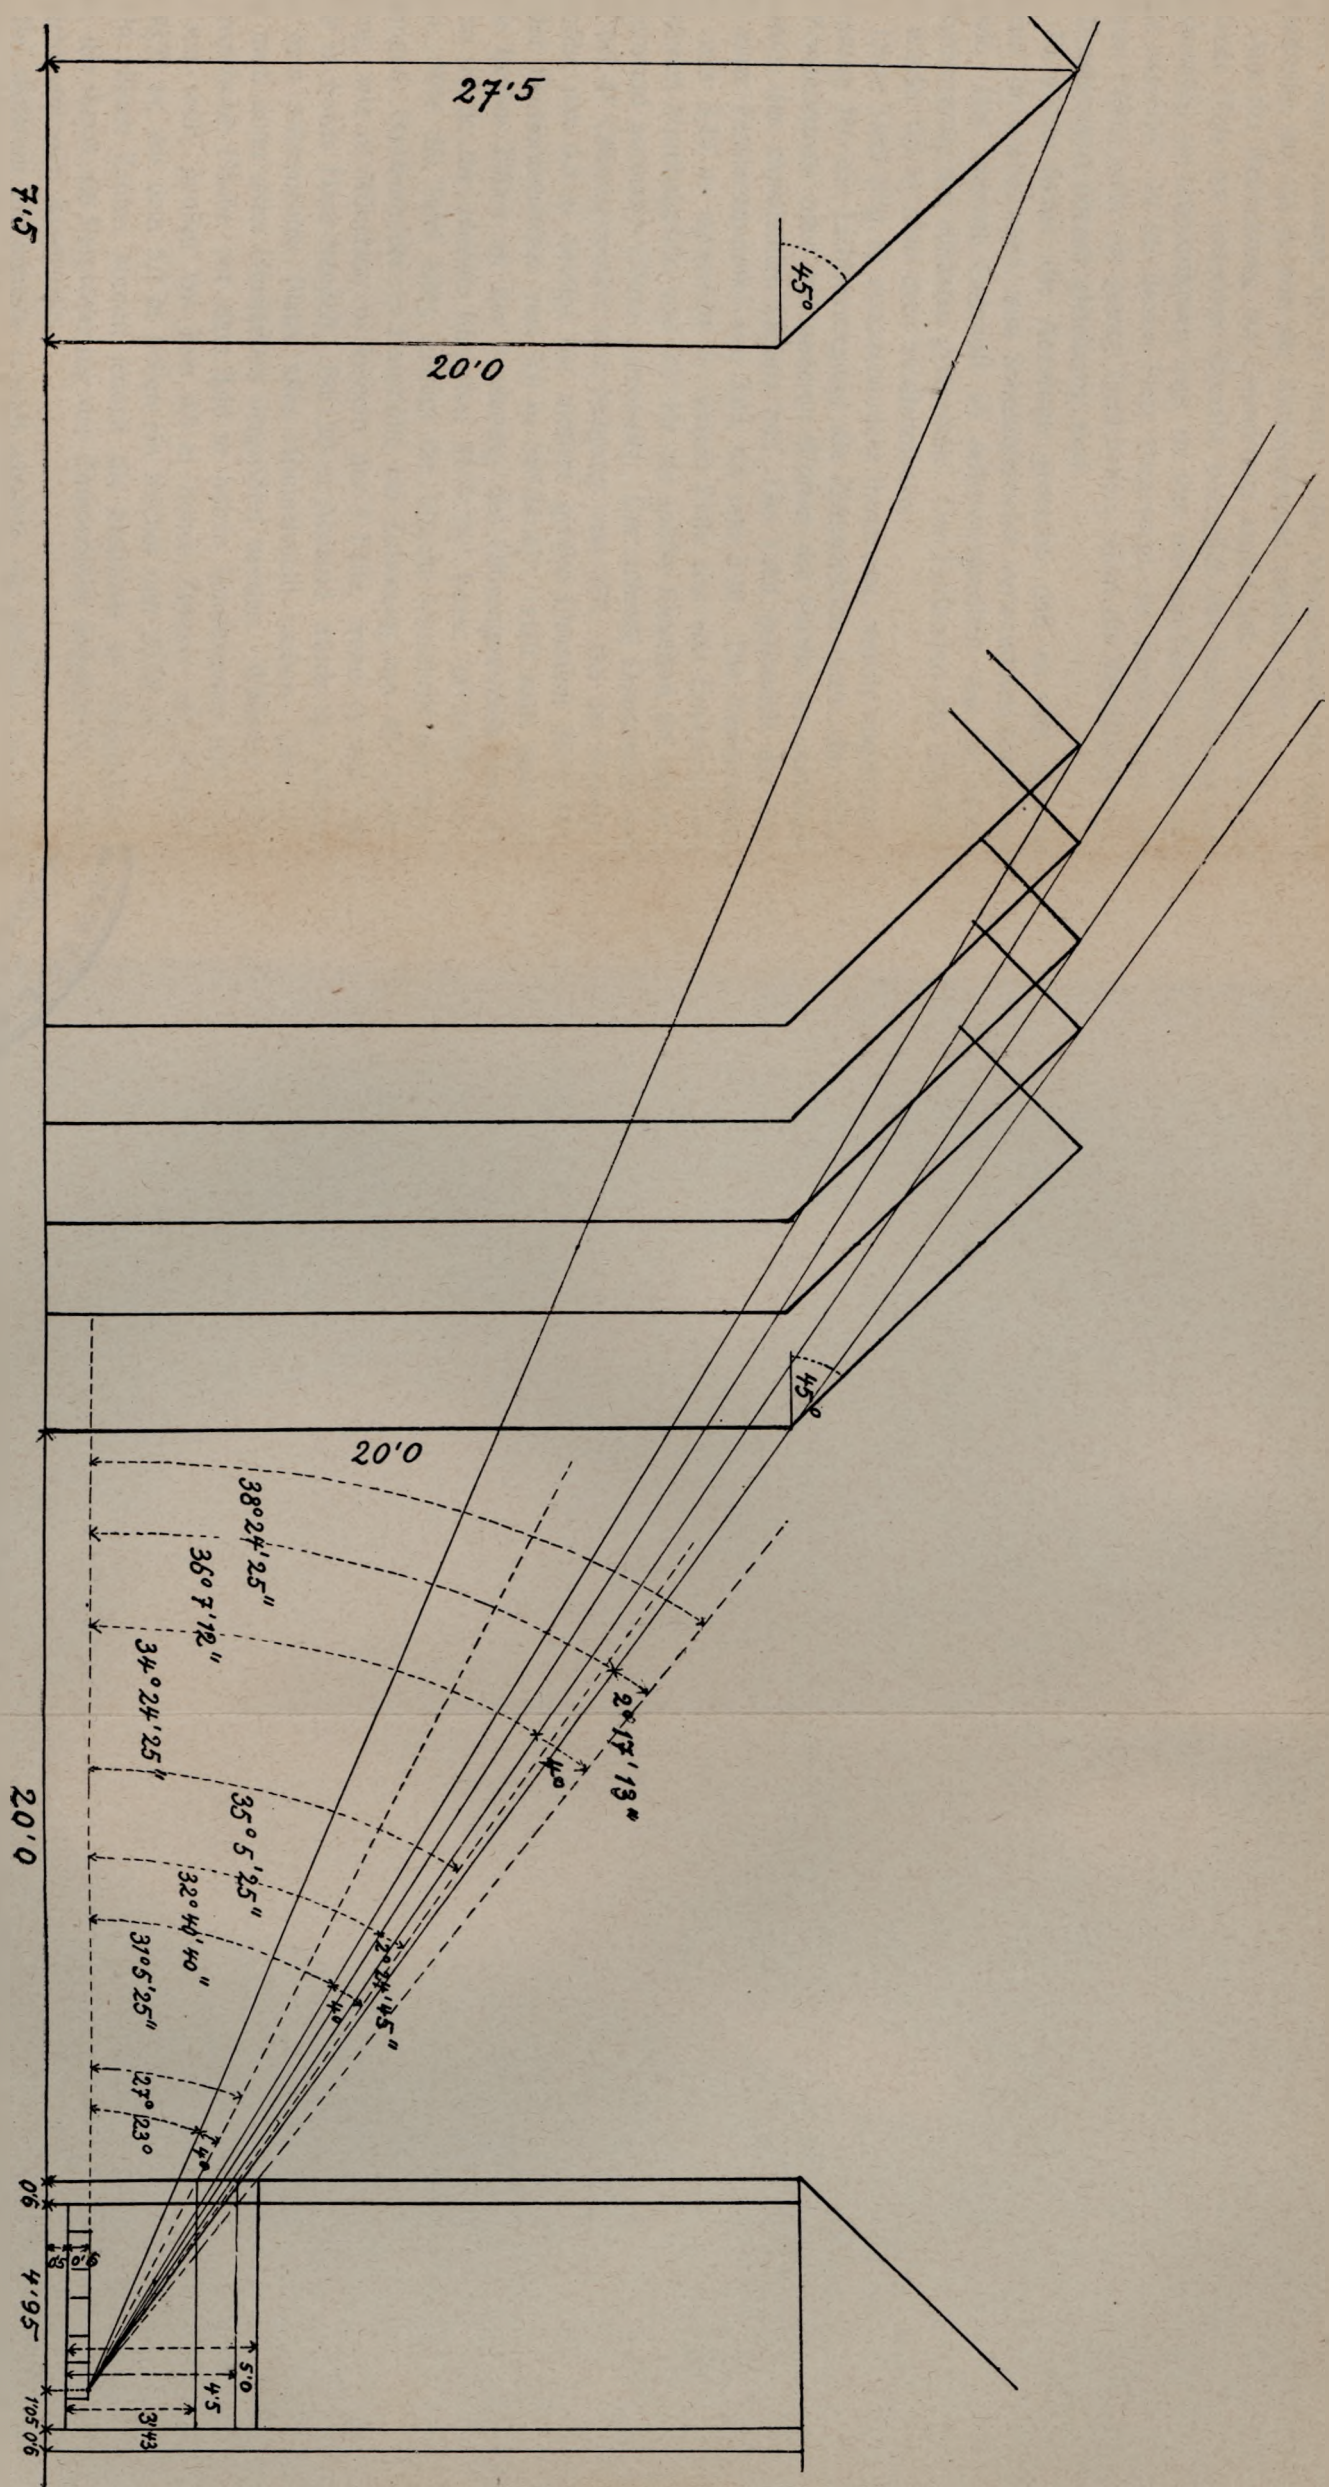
Elevationswinkel, Öffnungswinkel und Minimalabstand der Gebäude.
